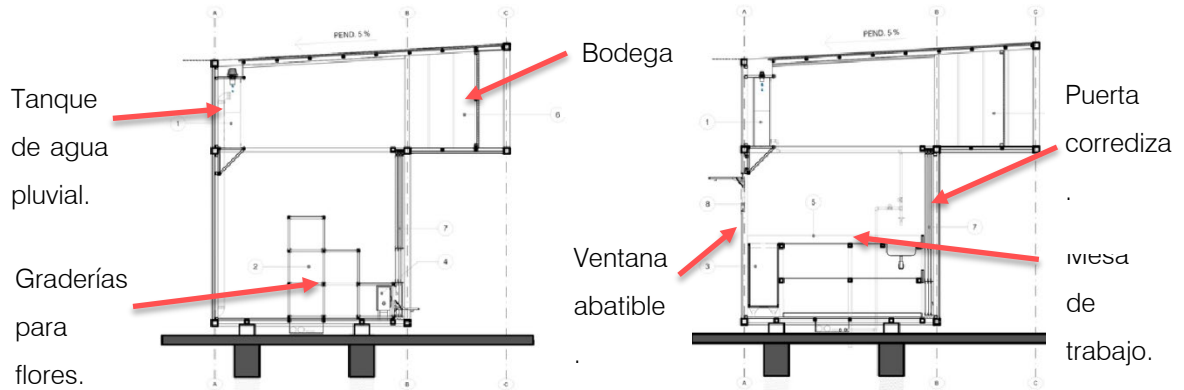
Planta de módulo de flores, Mercado de Flores, Calle 26, Bogotá
